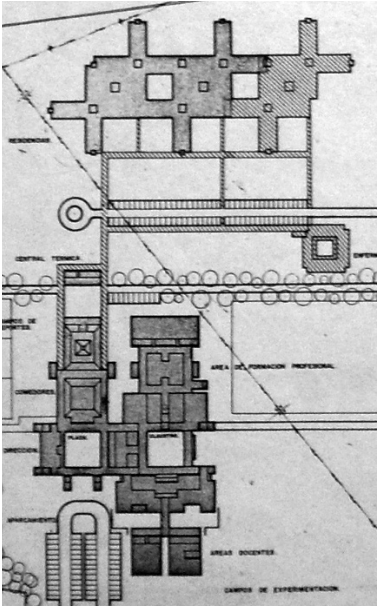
Planta general del Centro de Lardero con indicación de la solución propuesta por sus autores para el crecimiento de la zona de residencia.
